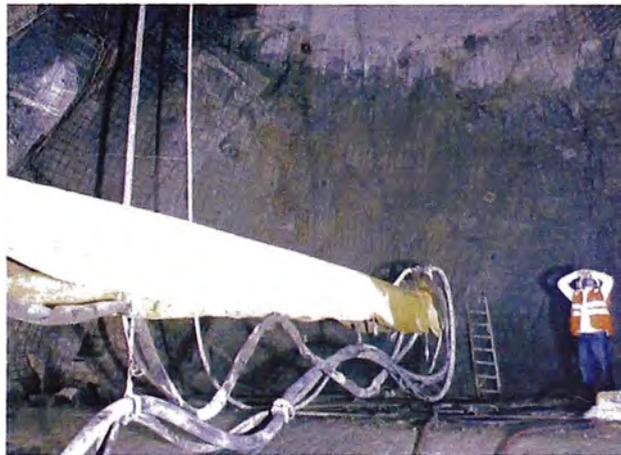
Trampa de Rocas - Zona de Revestimiento de Concreto
